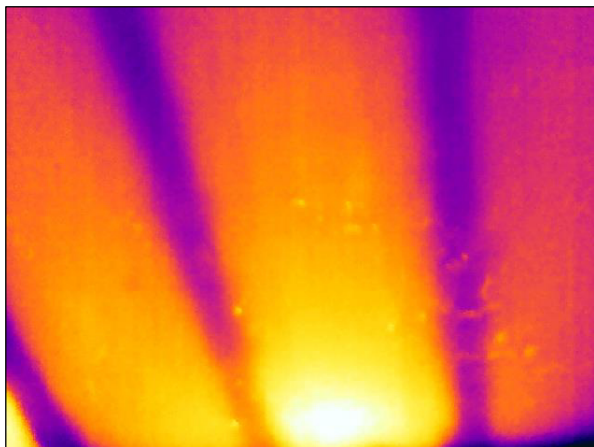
Piano terra, Spogliatoio 2: individuazione di un'area caratterizzata dalla presenza di un'infiltrazione attiva.
